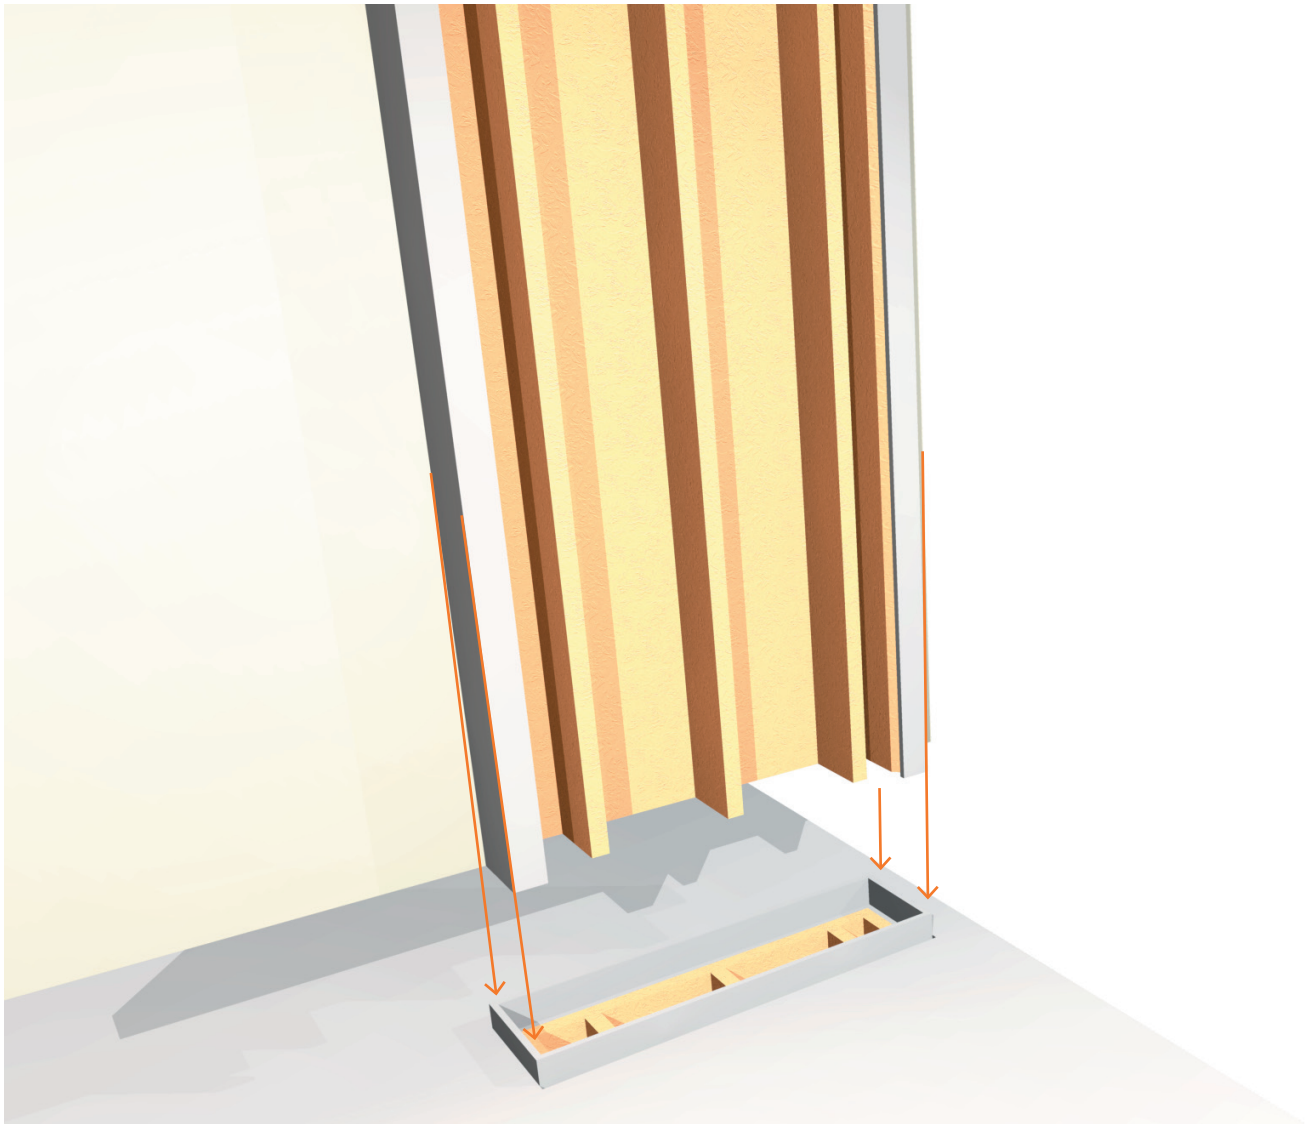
Einbaufolge eines vorgefertigten vertikalen Schachts: Auf das vorgefertigte Boden-Deckenelement mit der vorkonditionierten Deckenaussparung wird die Wand mit der vertikalen Trasse montiert. Die Rohrleitungen werden in das vorgefertigte Element eingelegt und verbunden. Die dauerhafte Zugänglichkeit kann durch eine einfach zu öffnende Verkleidung gewährleistet werden.
